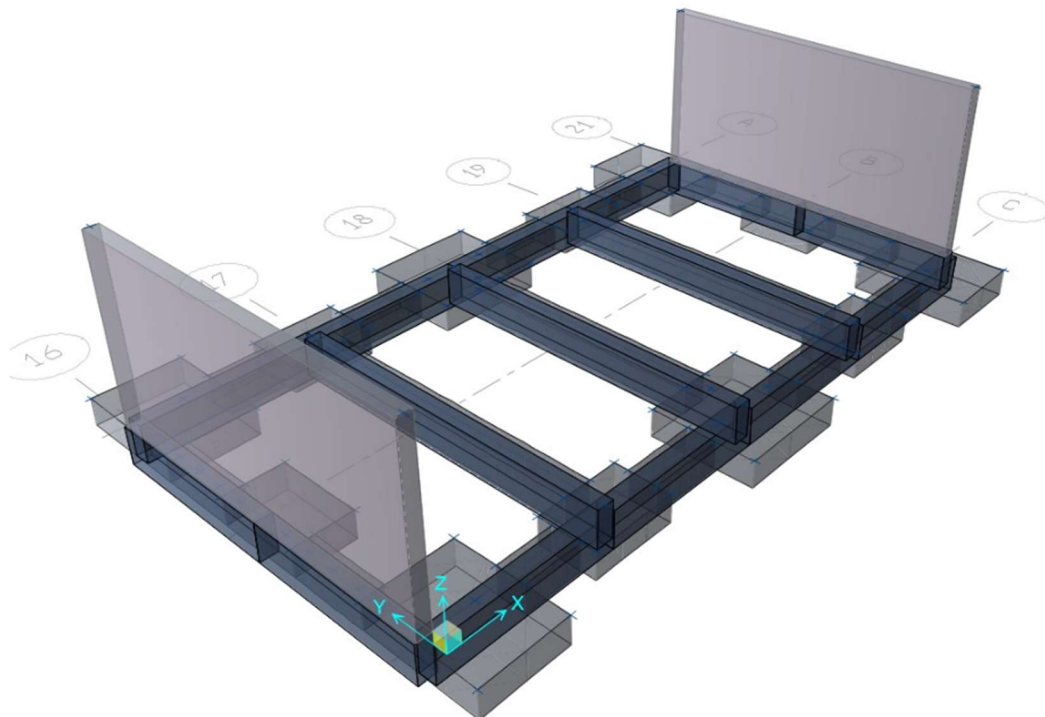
Modelado de cimentación de I.E N° 11526 Jesús Alfonso Tello Marchena.
